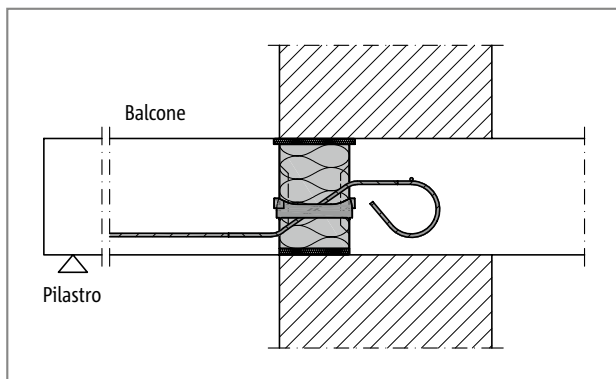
Schöck Isokorb® XT tipo QL: raccordo con appoggio su muratura termoisolante monostrato (XT tipo QL-V1 a V4)
